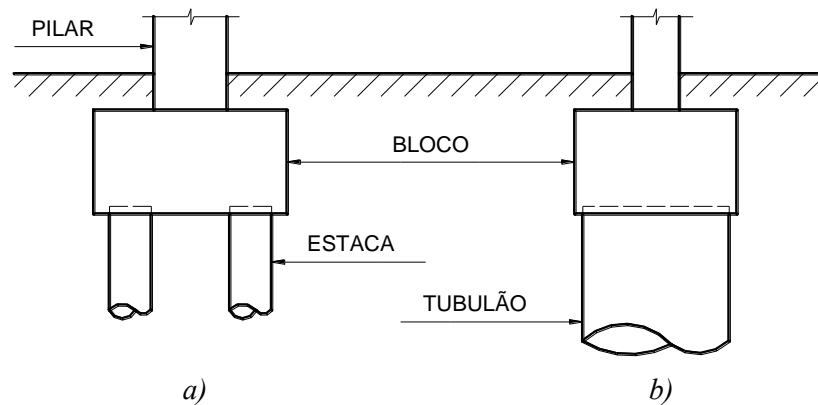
Bloco sobre: a) estacas; b) tubulão.
